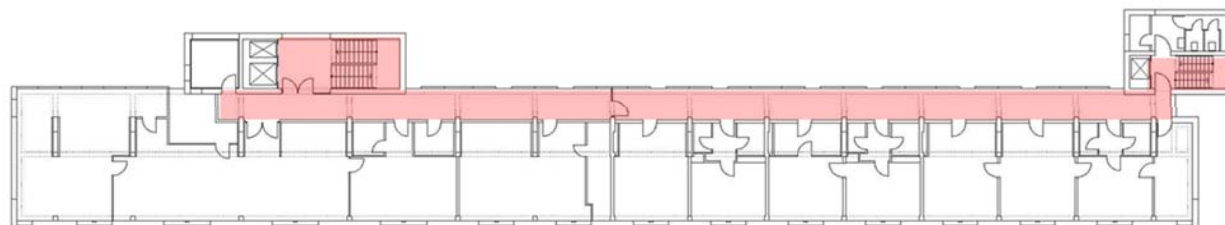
Grundriss Regelgeschoss 2.OG
